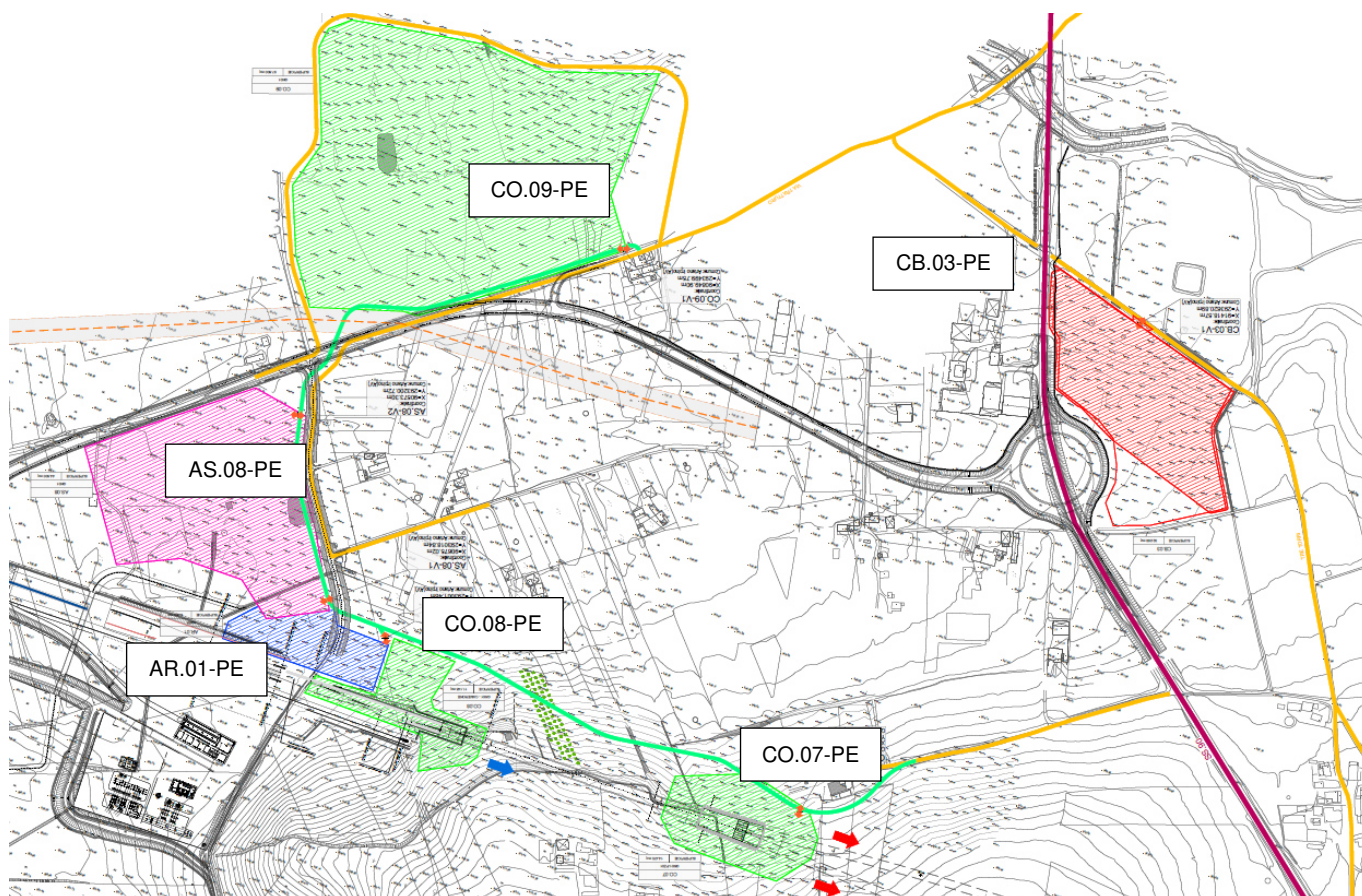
Ubicazione area di stoccaggio AS.08, cantiere base CB.03, cantieri operativi CO.07, CO.08 e CO.09, area armamento
